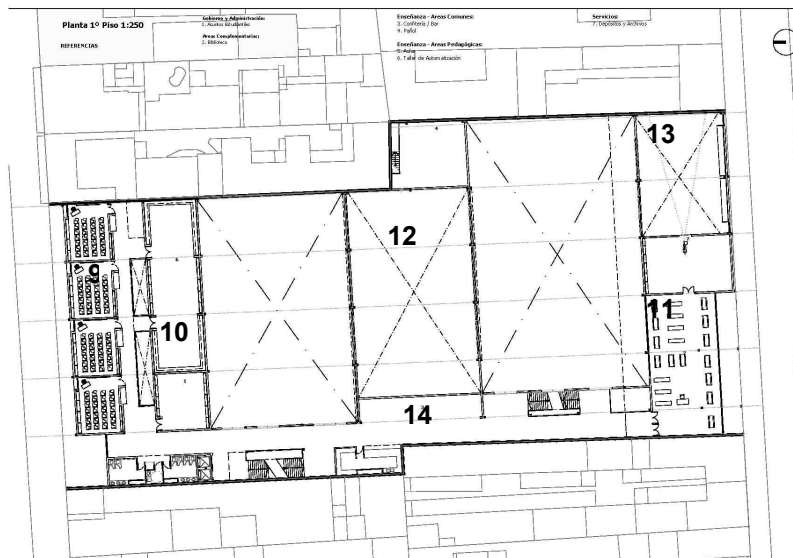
Planta 1º Piso (Nivel + 3,40 m)
